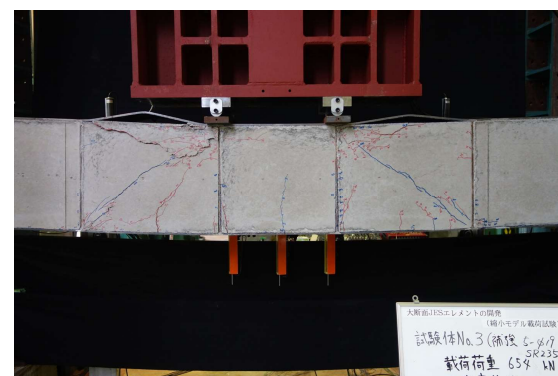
変形角 1/50 時点の損傷状況 (No. 3)
